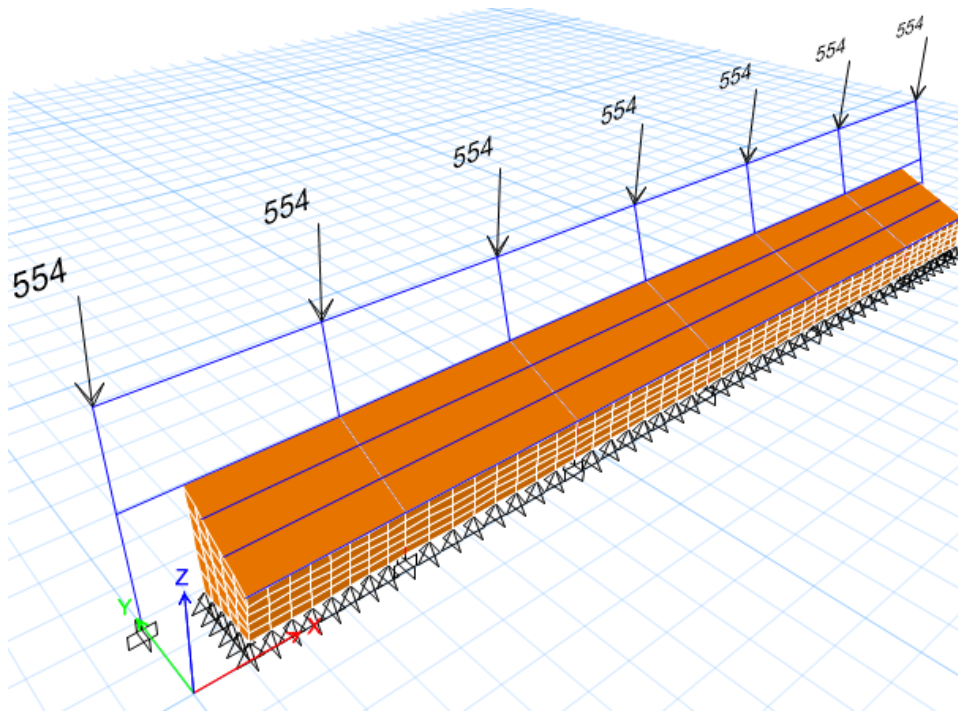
Modelamiento estructural aplicando carga muerta (Tribuna)
